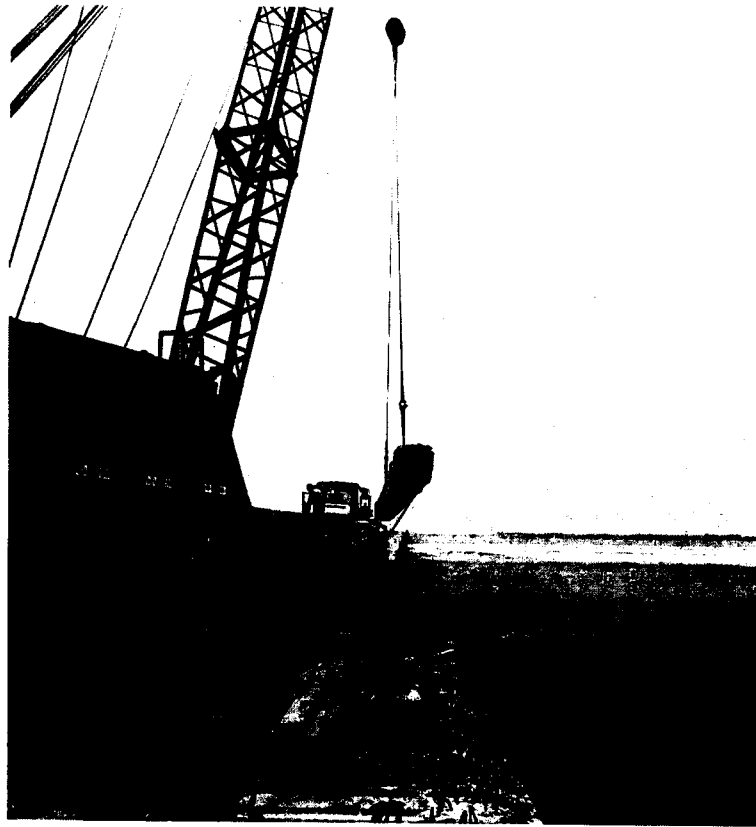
Traslado de pilotes hacia la zona del cabezo
